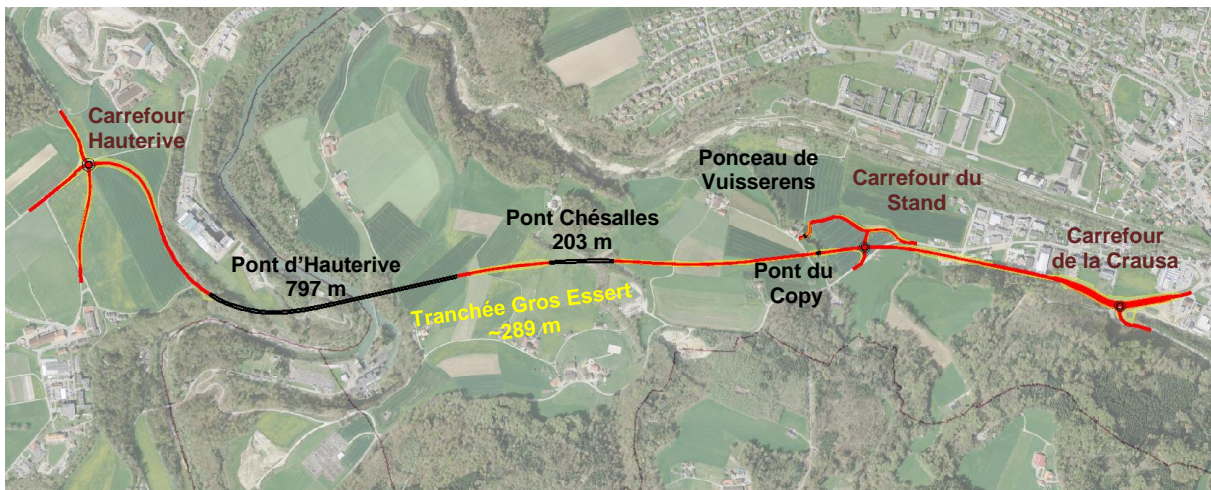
Situation du projet et principaux ouvrages (fond de plan : swisstopo)
